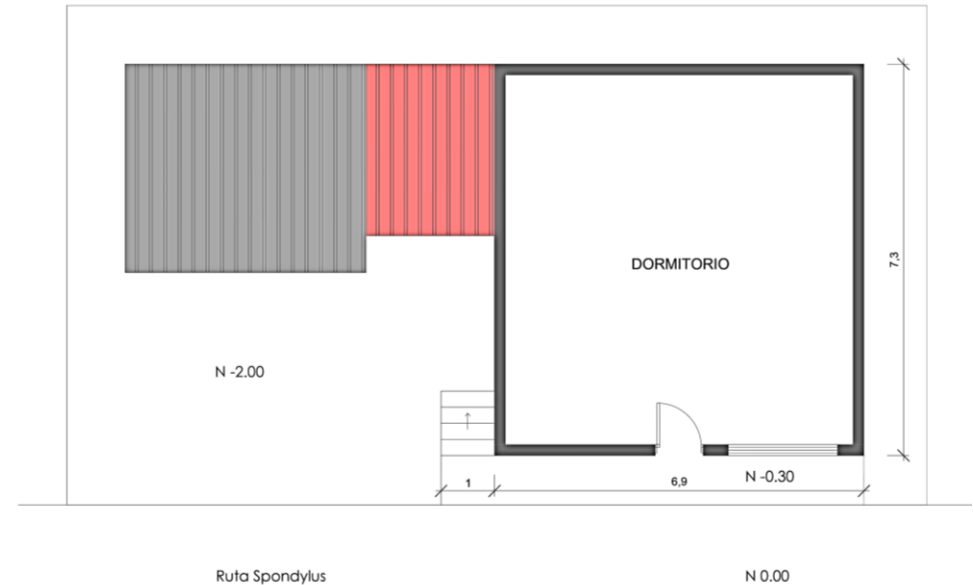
Planta Arquitectónica Vivienda 2 – Planta Baja
